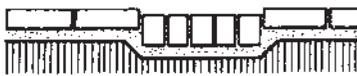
Alternancia soga de canto - tizón plano, por ejemplo al formar canales se realiza en lecho de mortero sobre hormigón.
